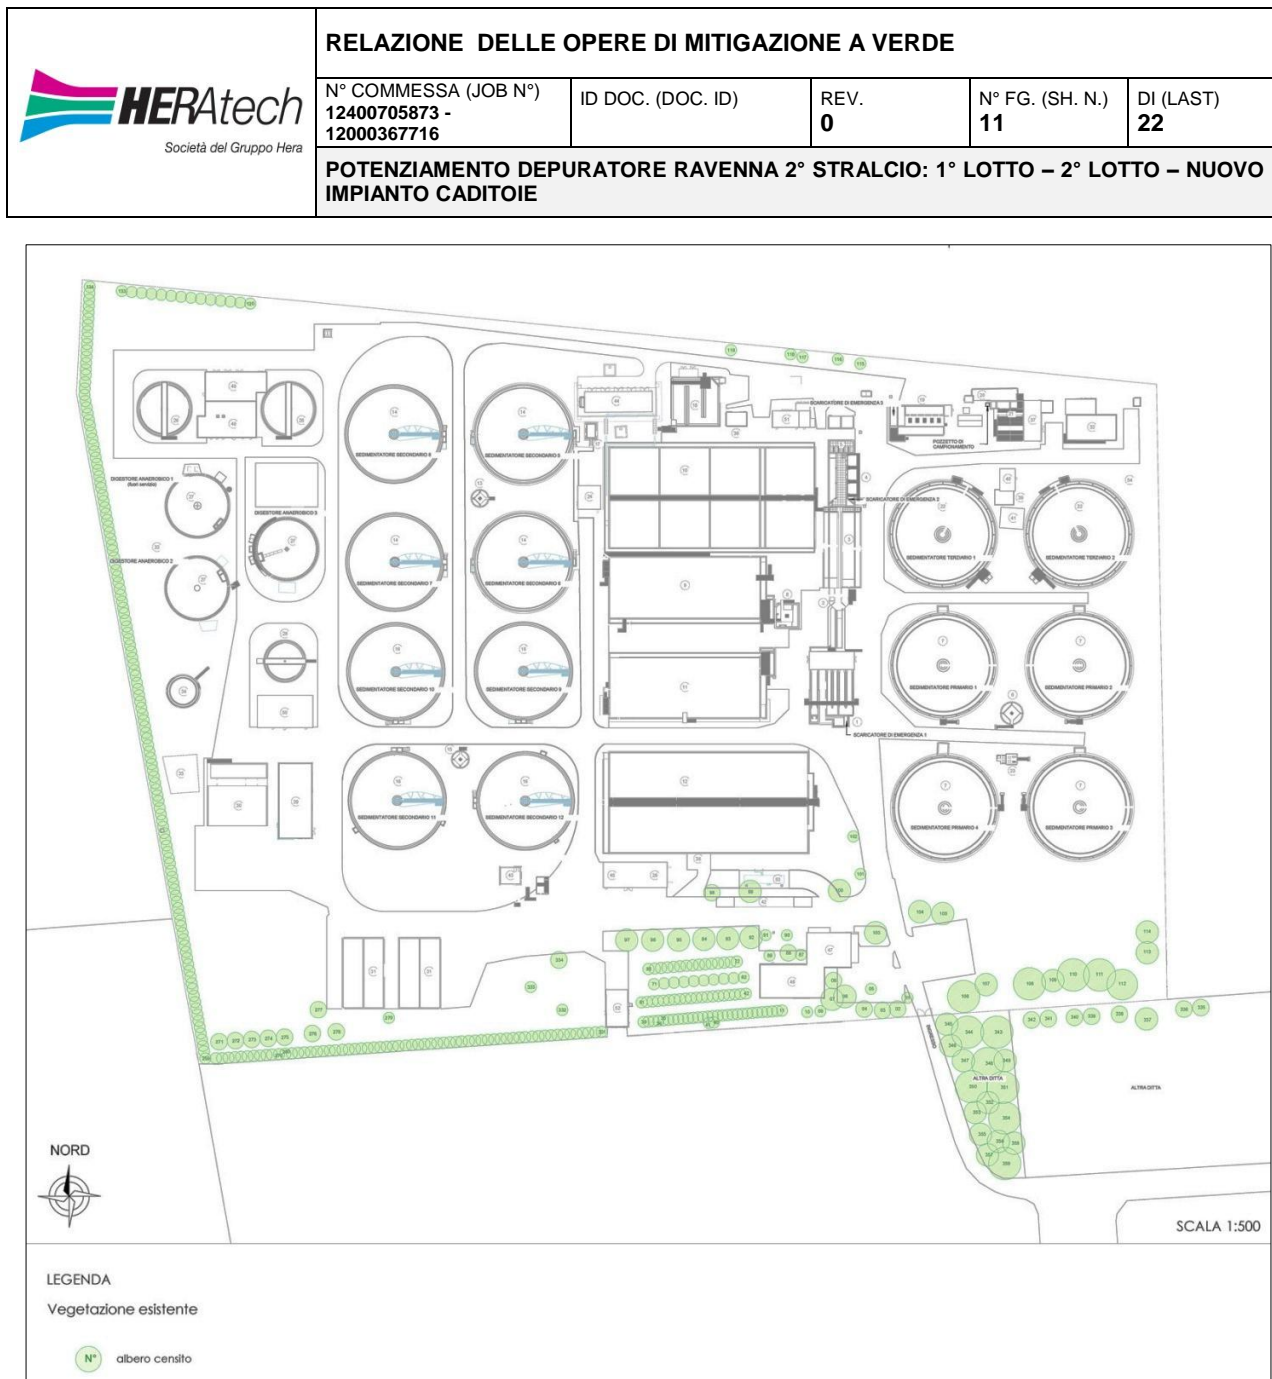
Planimetria di mitigazione a verde – Stato di fatto.
